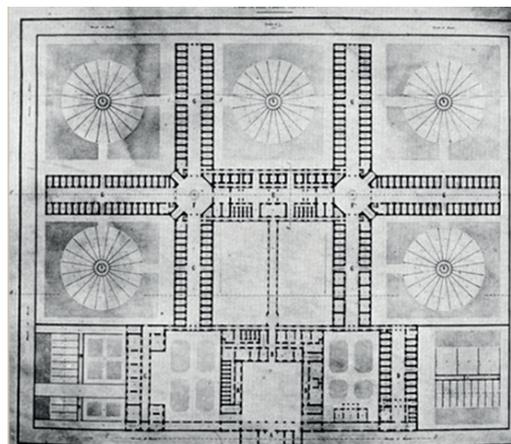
Pinanta Piano tipo, Giuseppe Polani
